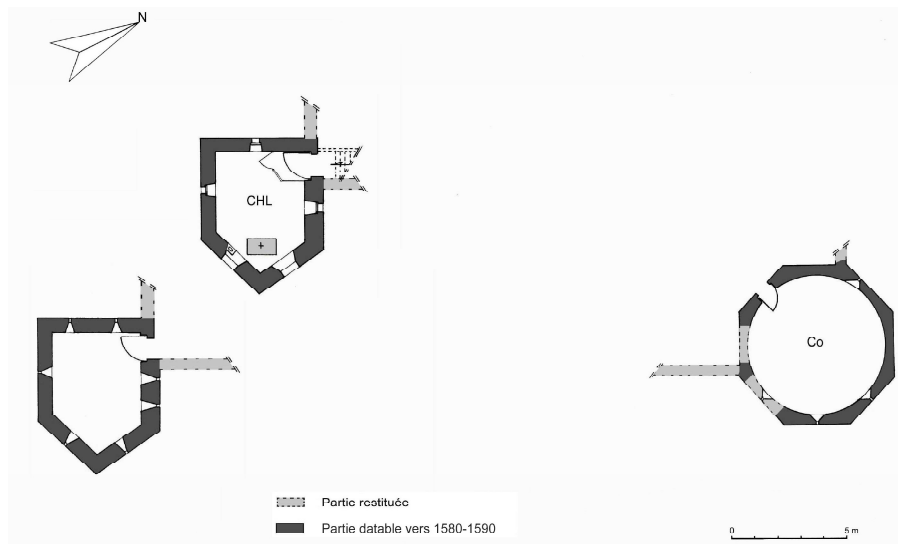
Les Mottes. La chapelle (rez-de-chaussée et premier étage) et le colombier vers 1580-1590.
